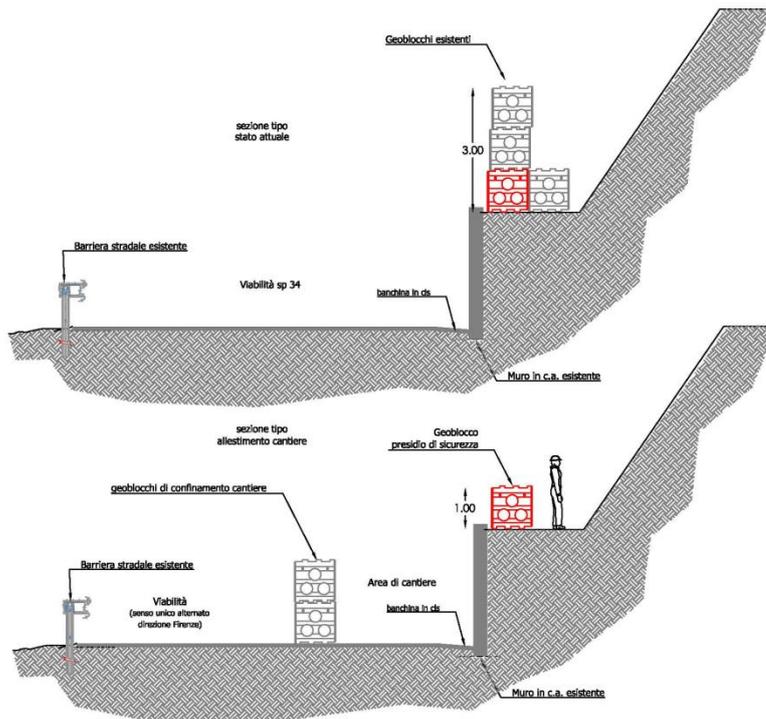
Sezione tipo allestimento cantiere Fase 3 e fase 4
